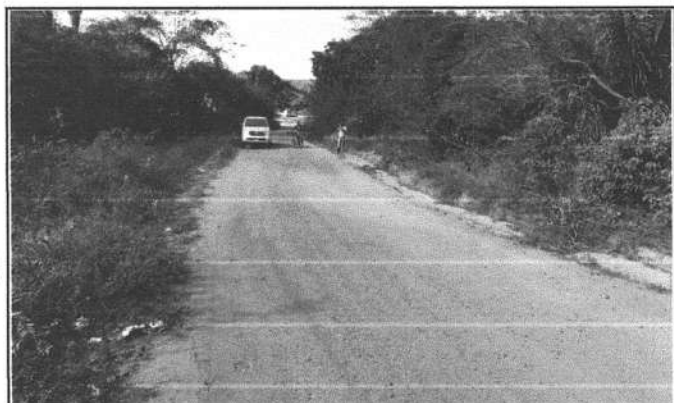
LOCAL DA CONSTRUÇÃO - BUEIRO
